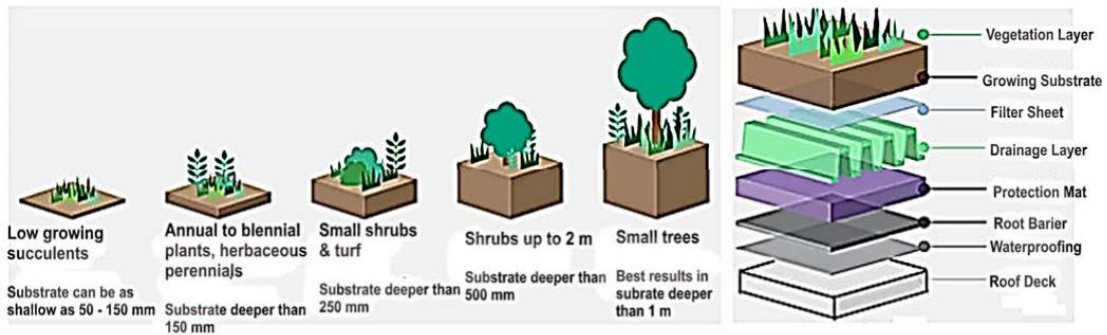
32 ambaran umum konstuksi urban farming pada bangunan
